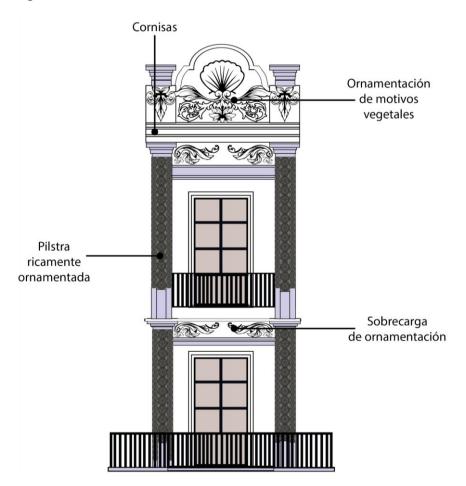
Detalles de fachada del inmueble con dirección 11 norte 2A
